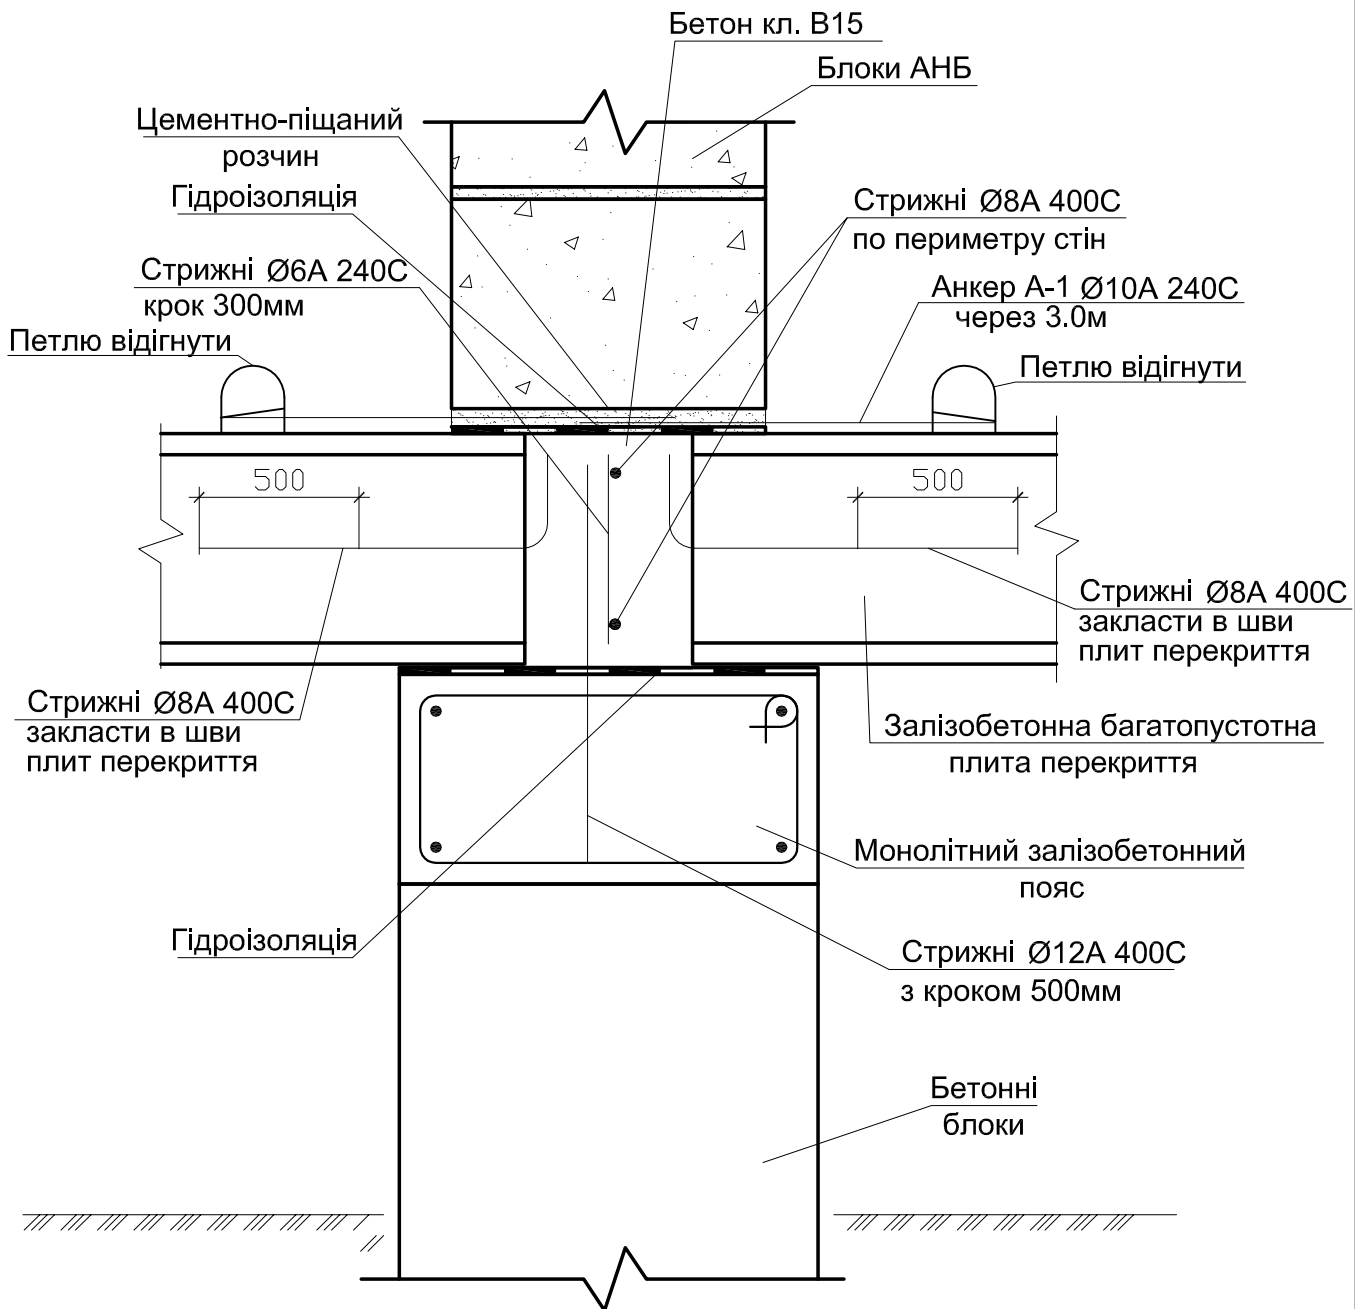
2-9. Спирання залізобетонного перекриття на фундамент внутрішньої стіни
